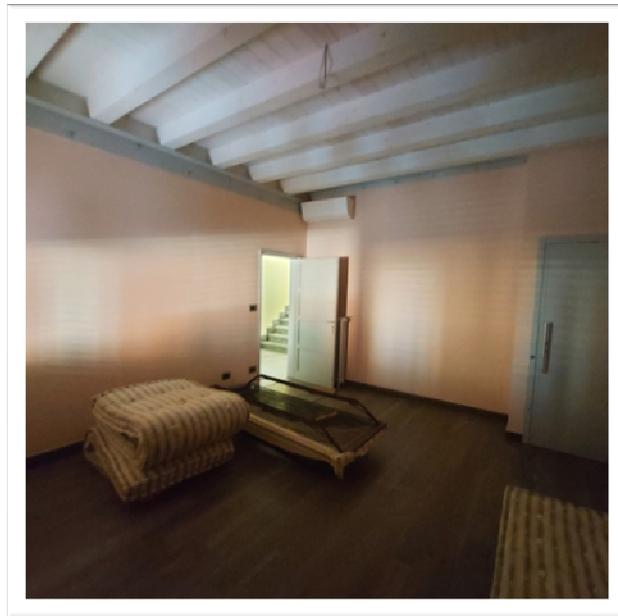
P1 Letto2 (part. piattaforma elevatrice)
